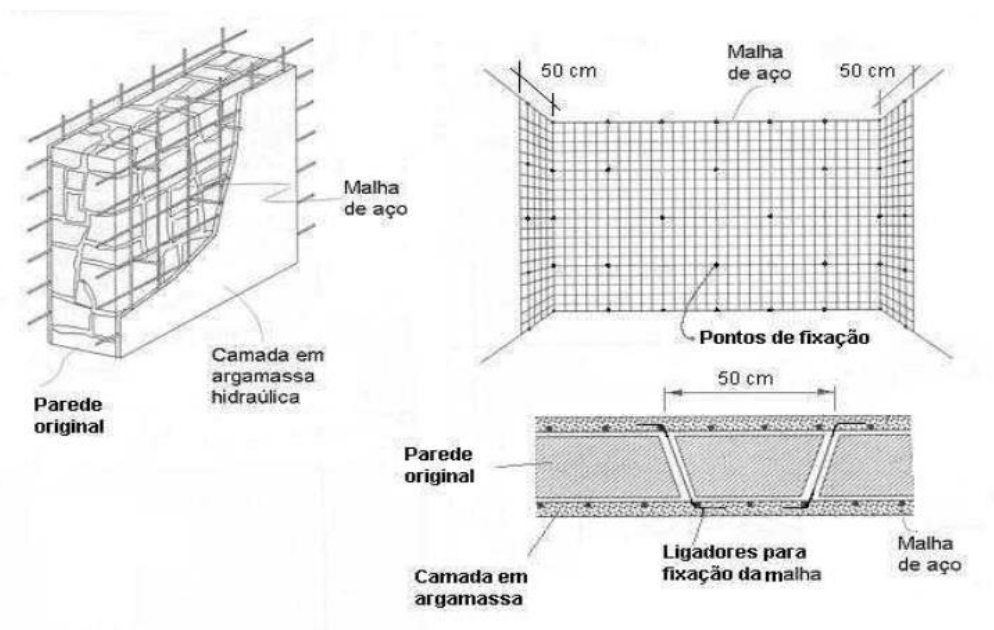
Aspetos construtivos da técnica de encamisamento (Meli, 1998).
